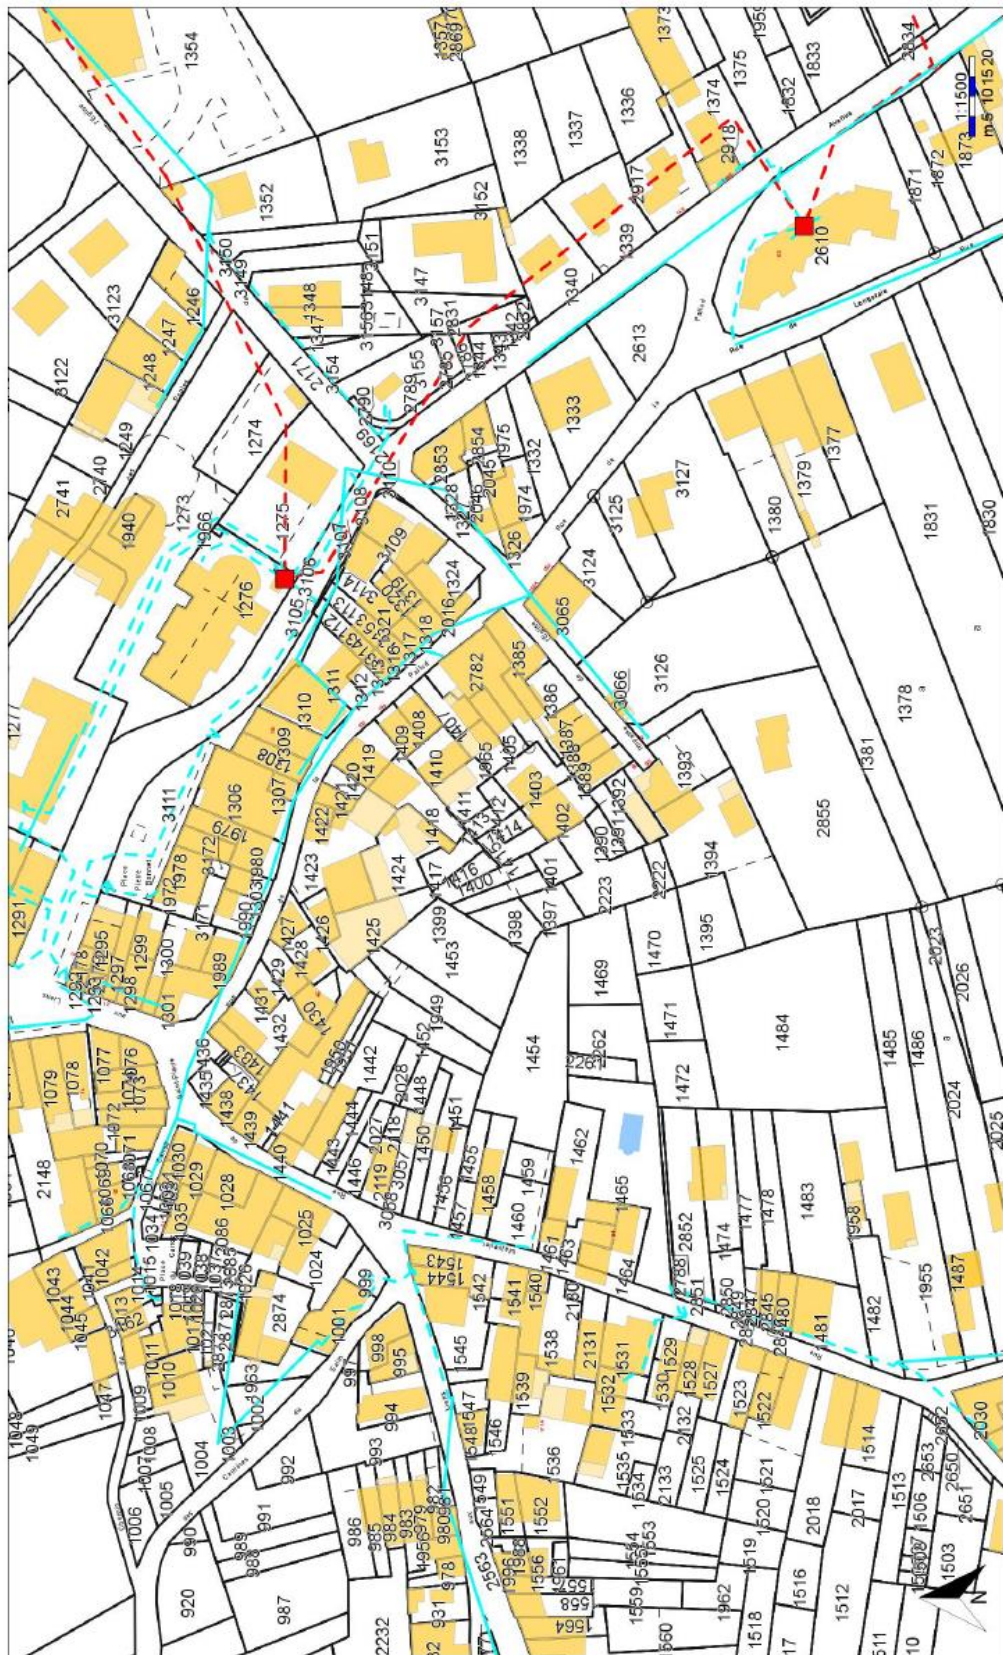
Extrait du plan général du réseau d'alimentation en eau potable
